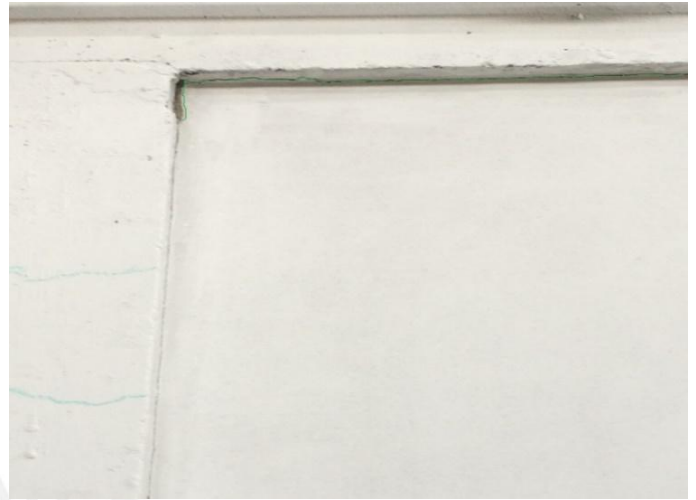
Primeras fisuras en el nudo entre columna y viga.
